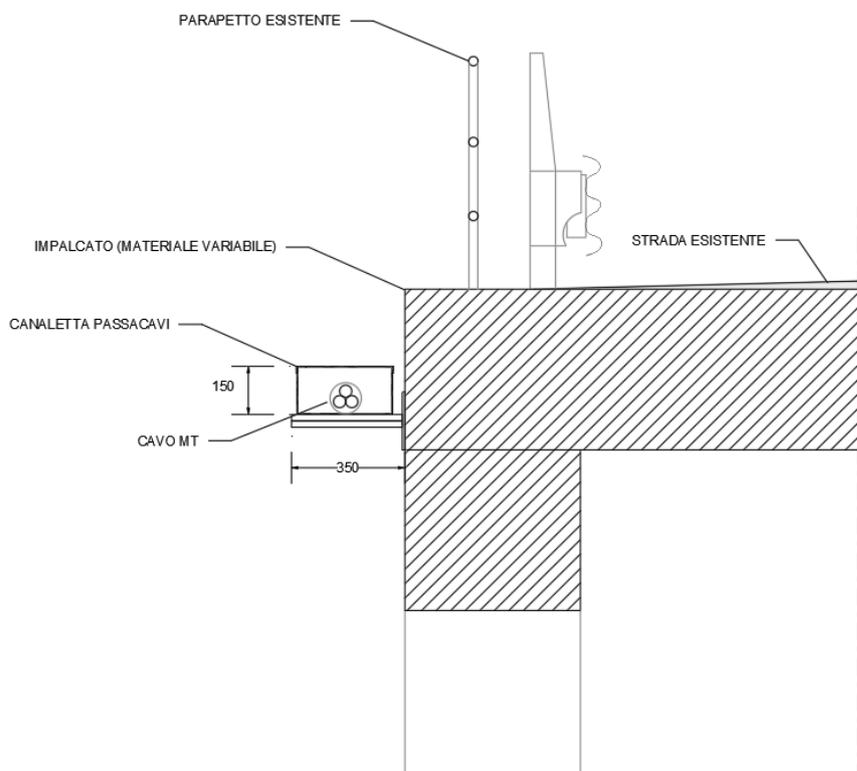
Tipologico della sezione del cavidotto in canaletta in fiancheggiamento dell'attraversamento carrabile per cavo AT.
